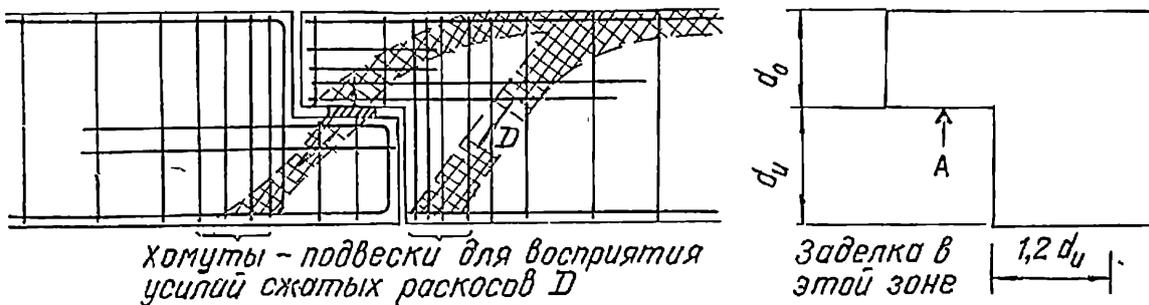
7. На опорах с подрезкой необходимо располагать подвешивающую арматуру
